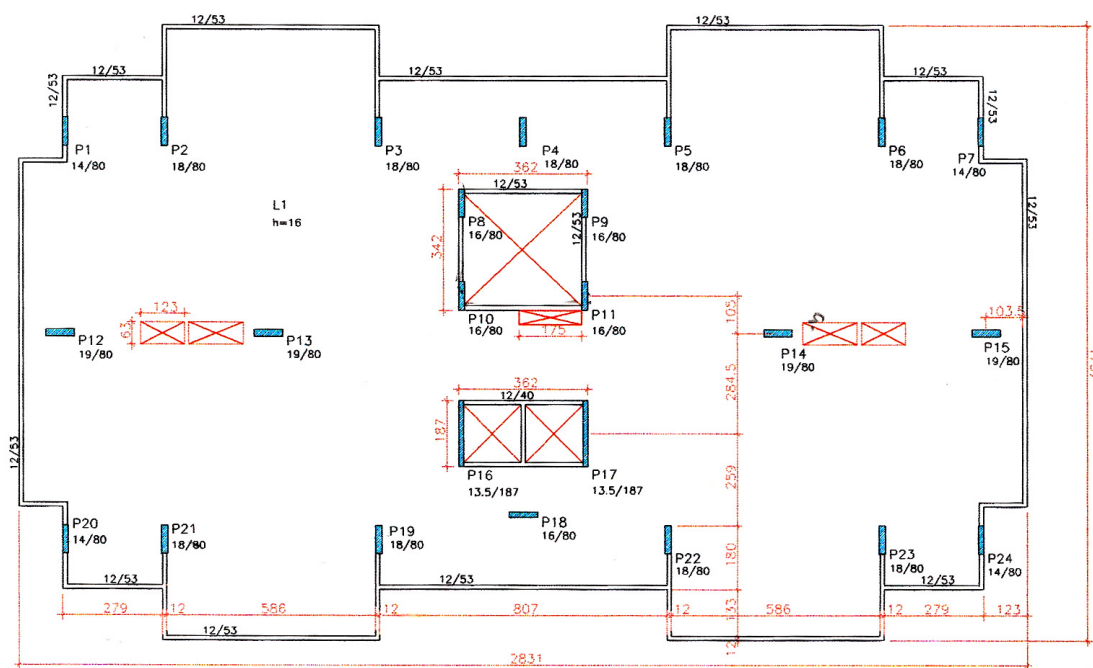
Planta baixa do primeiro exemplo (MARTINS, 2003)
